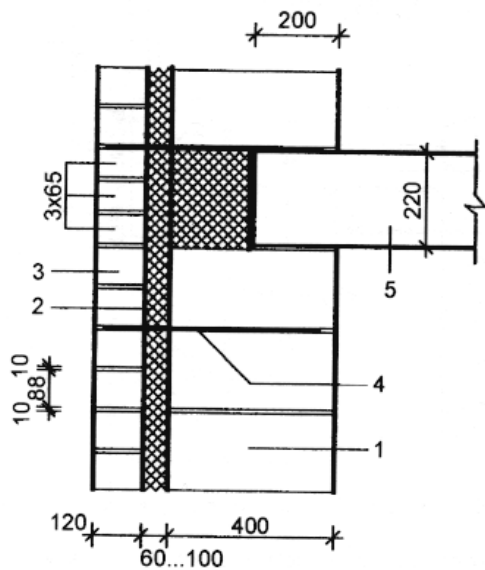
Трёхслойная стена с внутренним утеплителем:
